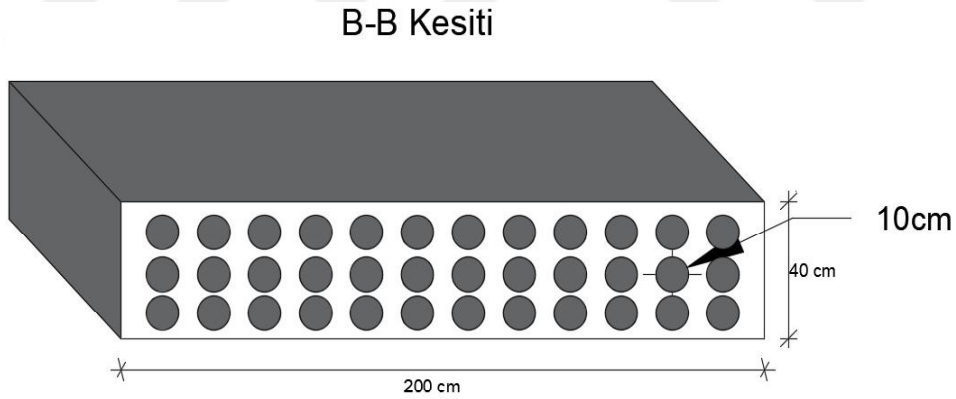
Döküm yönüne paralel donatılı karotların alınması için üretilen betonarme blok
